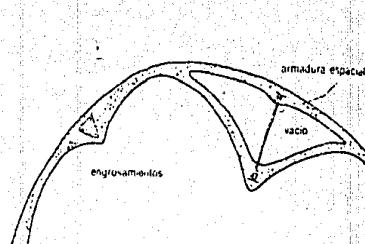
Vacíos de corazón abierto para digerir la cubierta sin el caso de armaduras espaciales de ciertas dimensiones.
